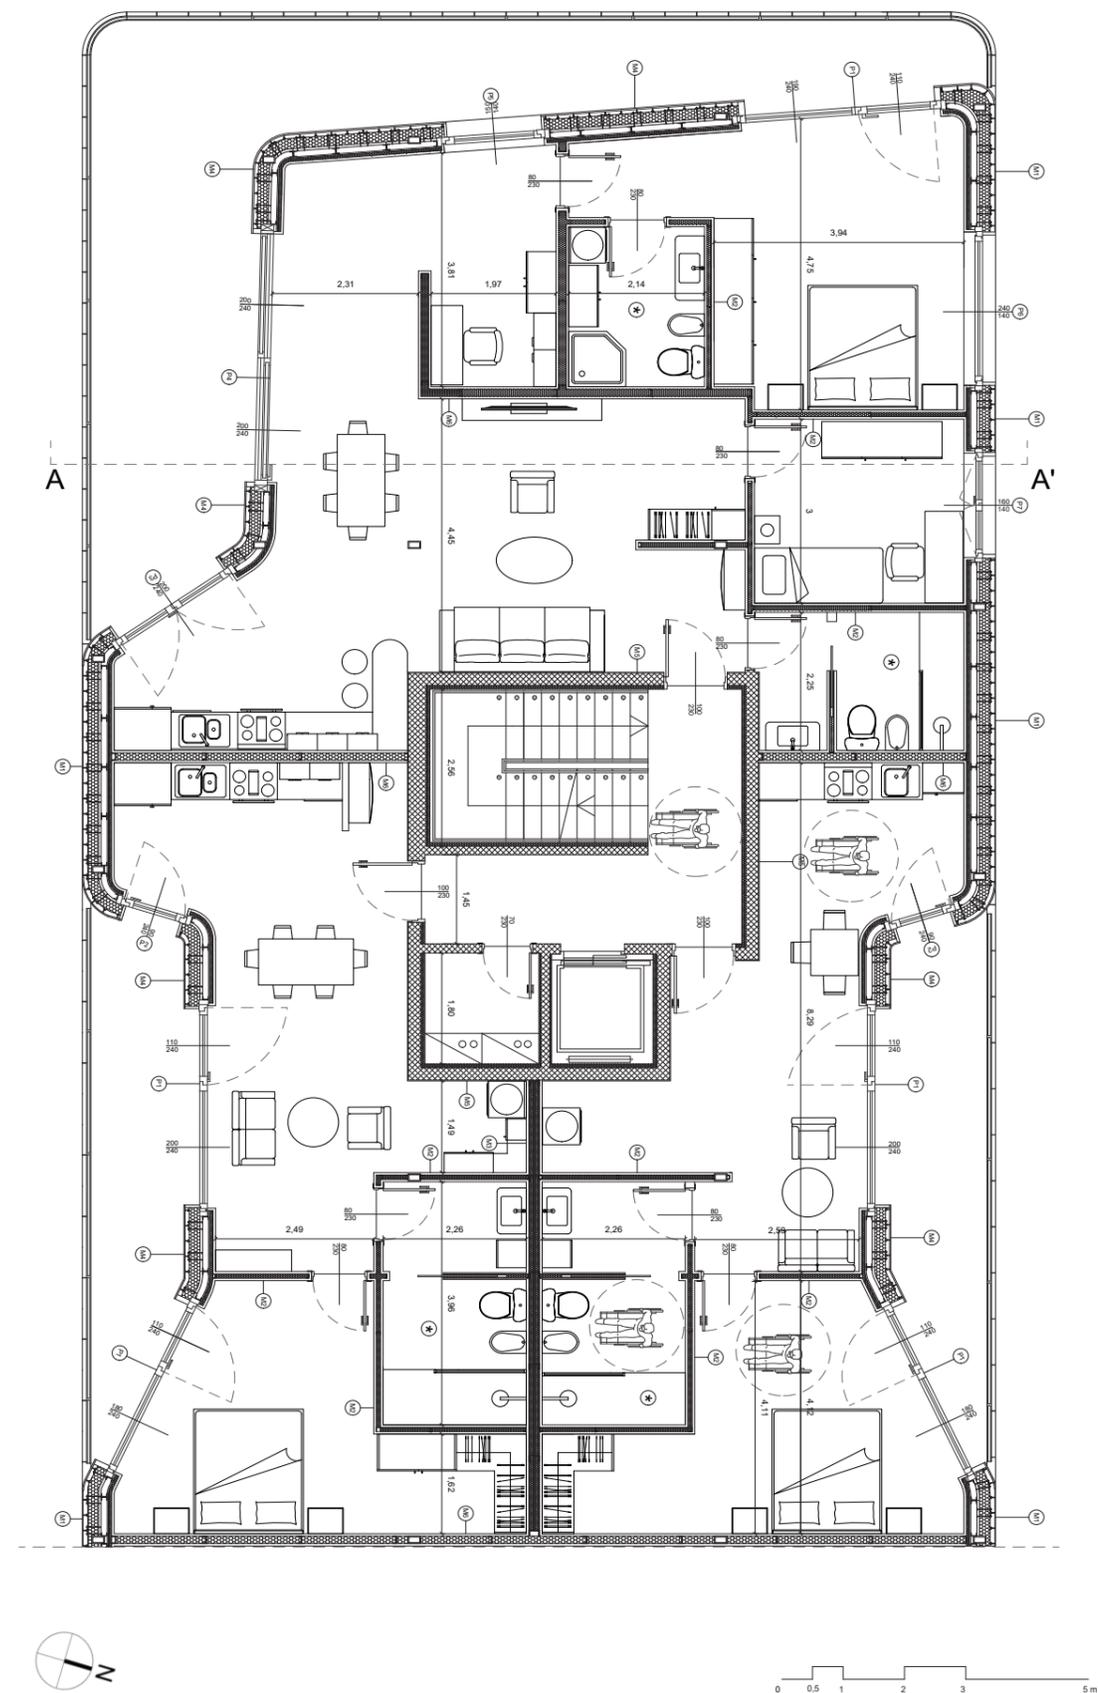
Planimetria con dettagli tecnologici/costruttivi edificio E
